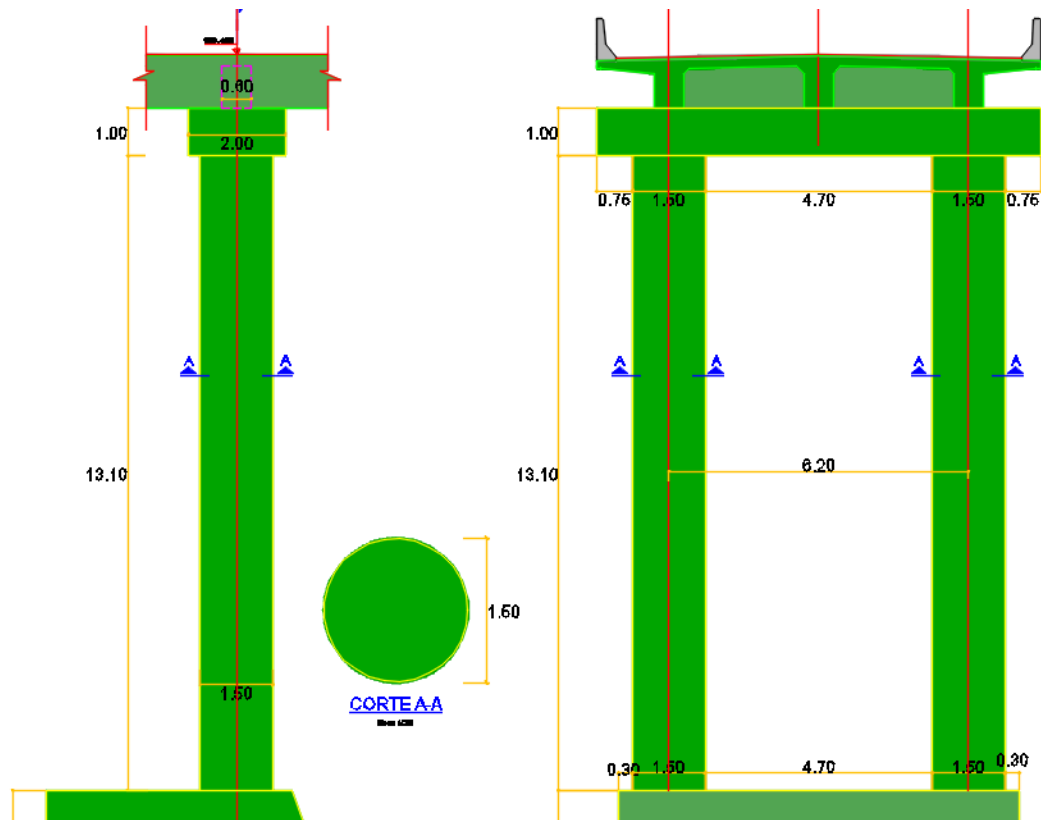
Elevación (izquierda) y vista frontal (derecha) de pilares de arranque
